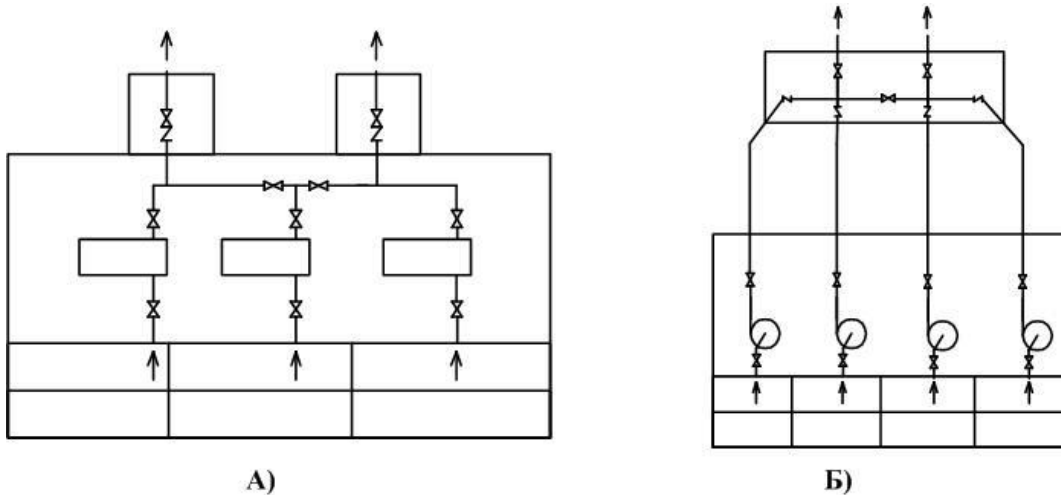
Схеми розташування засувок при трьох робочих і одному резервному агрегатах
